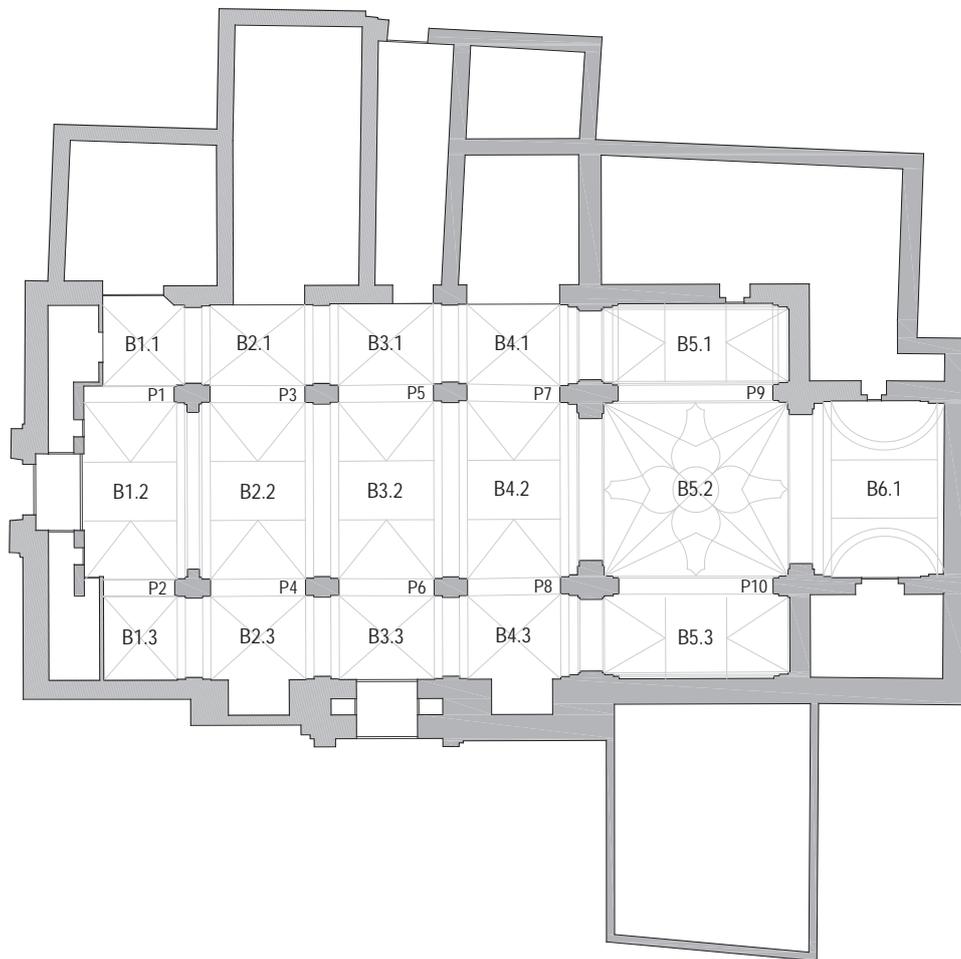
Planta del conjunto en el estado actual y denominación de los elementos estructurales.
